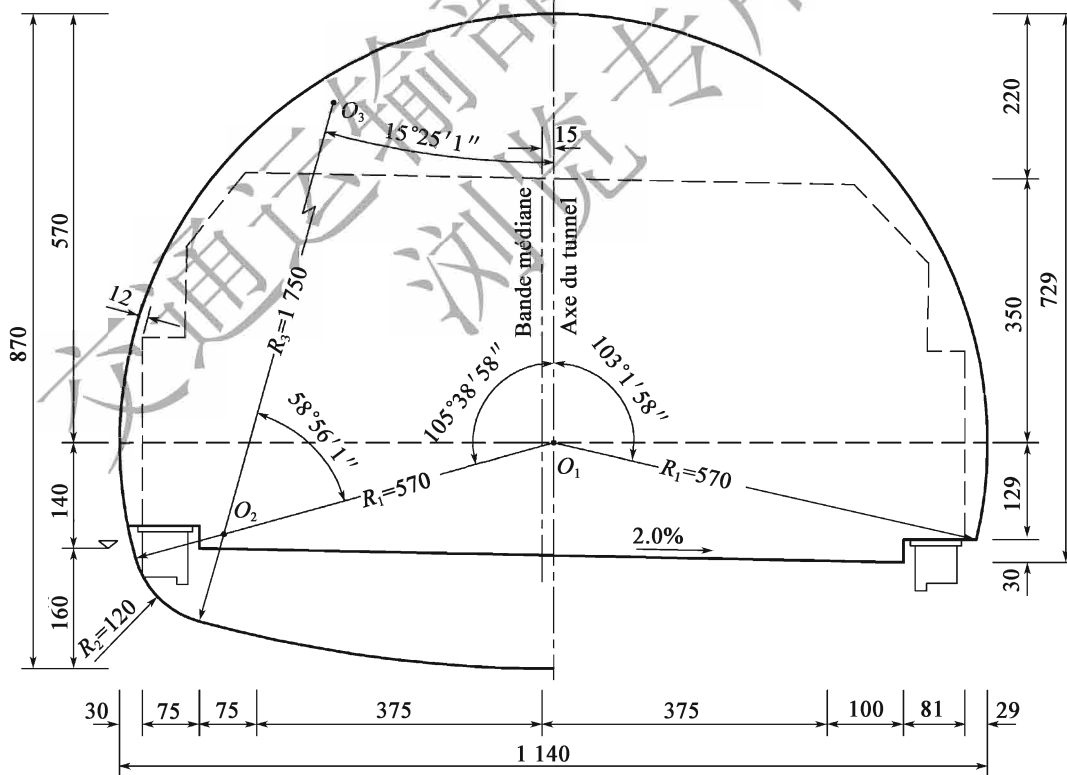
Gabarit du tunnel autoroutier et du tunnel routier de première classe à deux voies(100km/h) (unité:cm)
